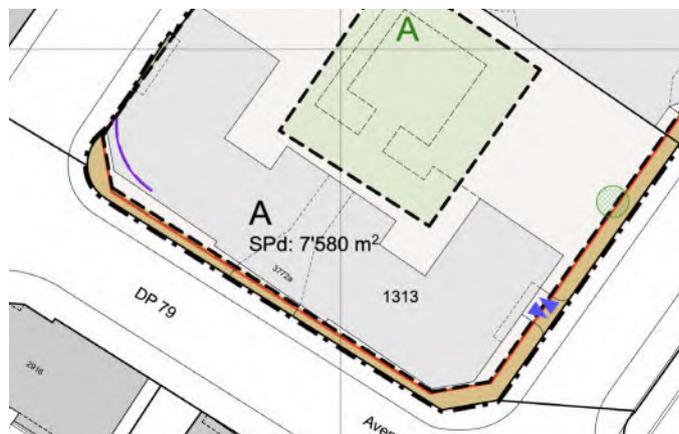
Nouvel alignement sur le périmètre d'implantation des constructions A
